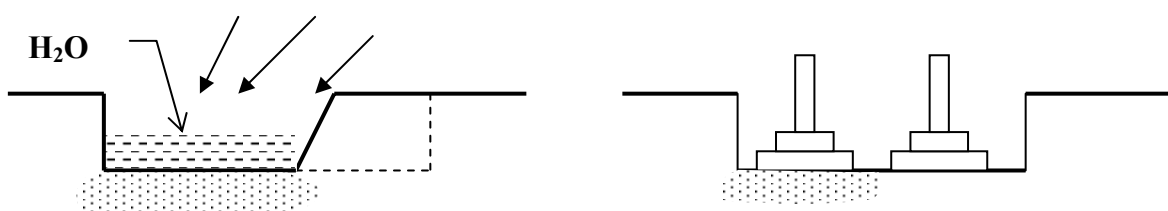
Неравномерные осадки расструктурирования при замачивании (увлажнении) грунта
